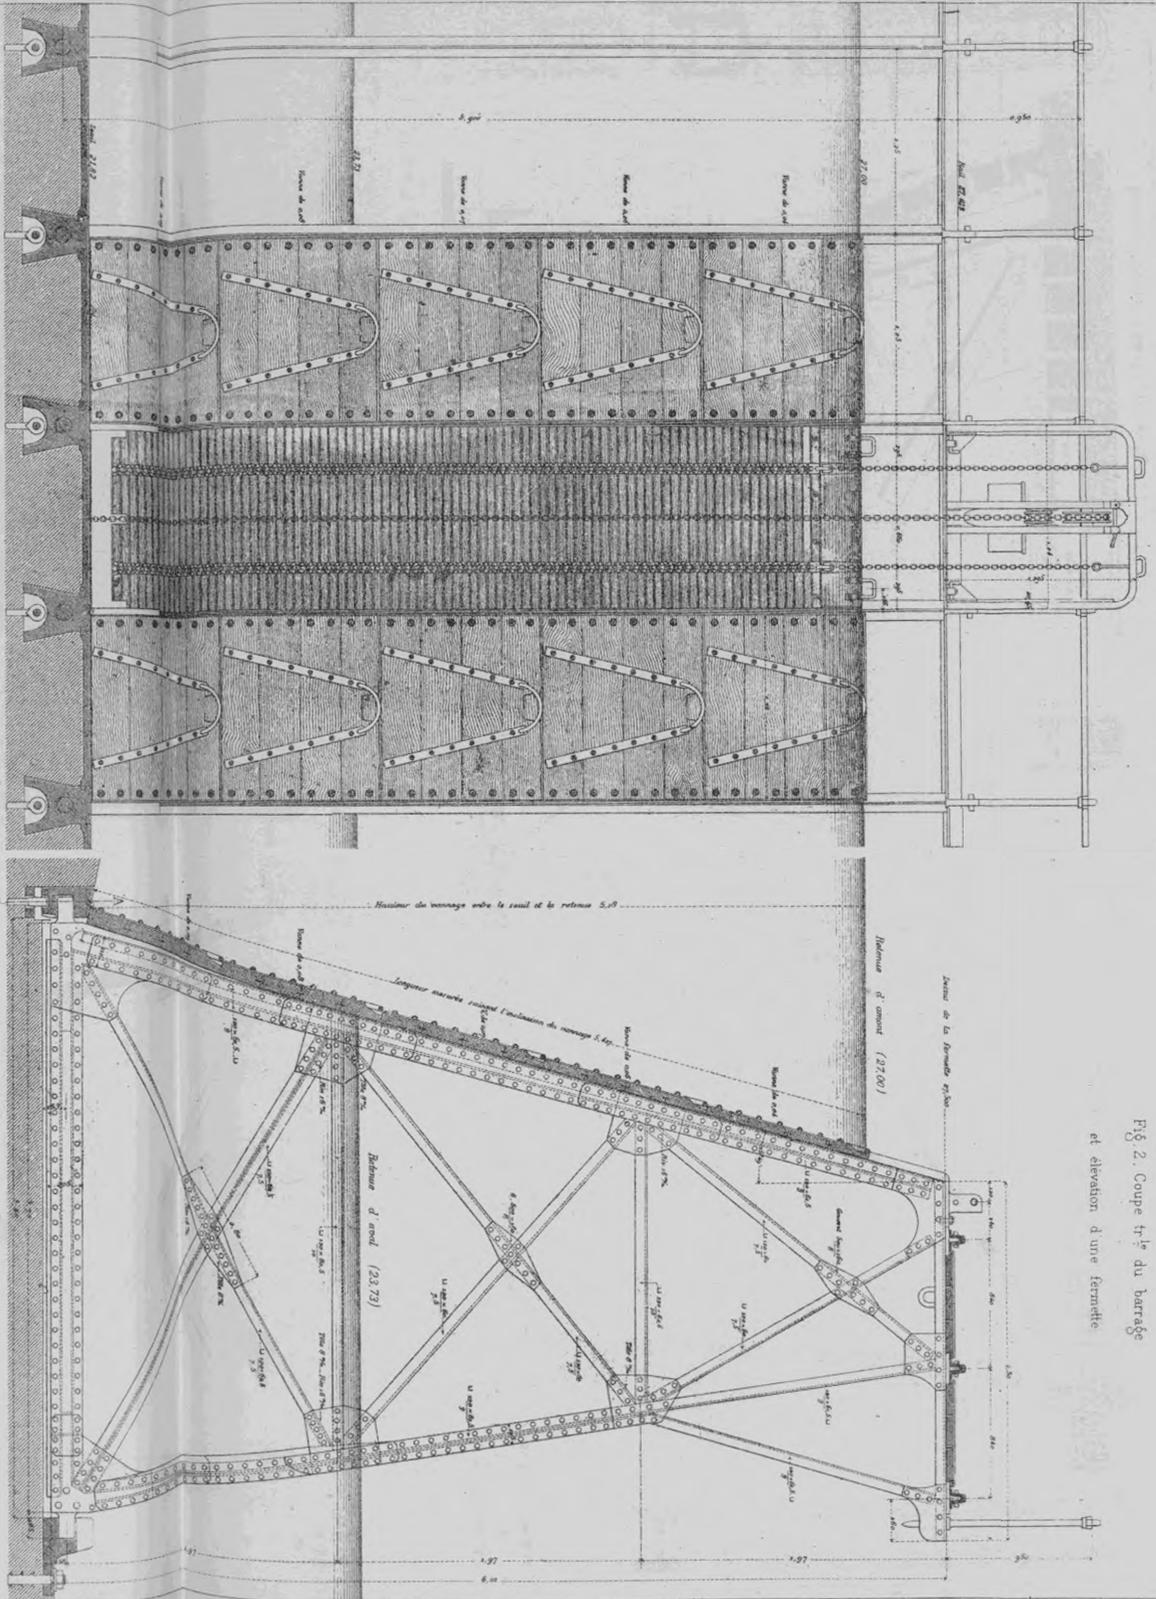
Coupe tr<sup>ie</sup> du barrage et elevation d'une fermette
